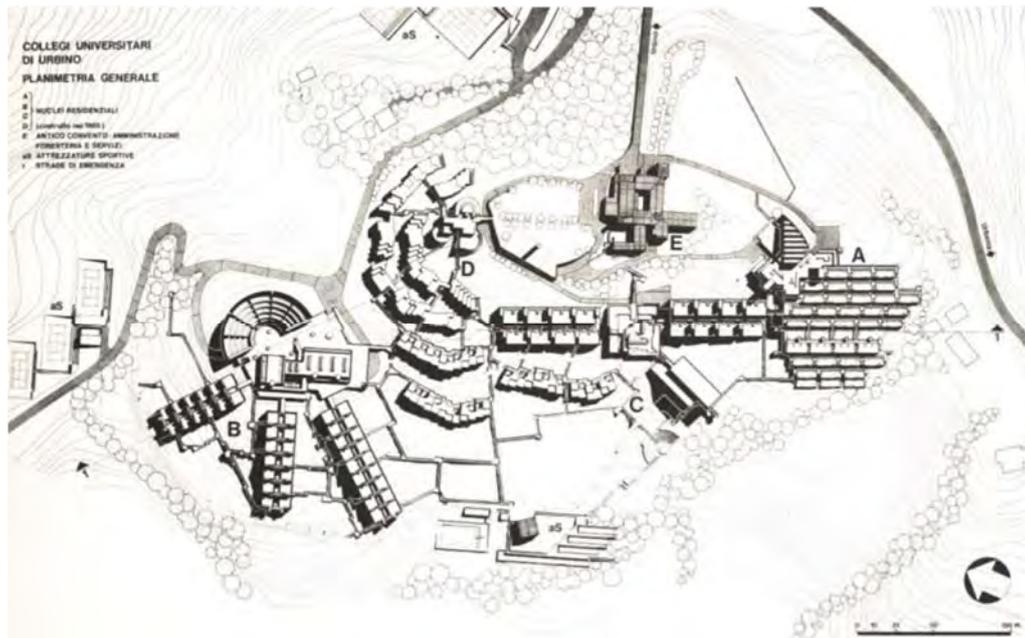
Collegi Universitari di Urbino. Planimetria Generale
